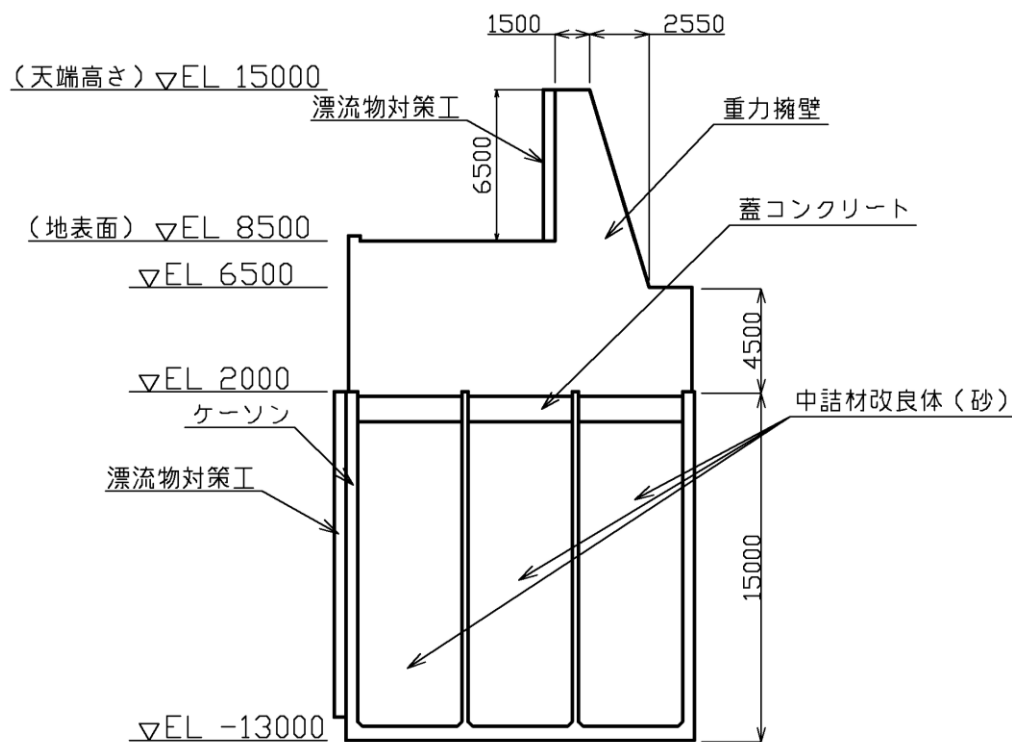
防波壁 (波返重力擁壁) の構造図 (④-④断面) (断面図)
